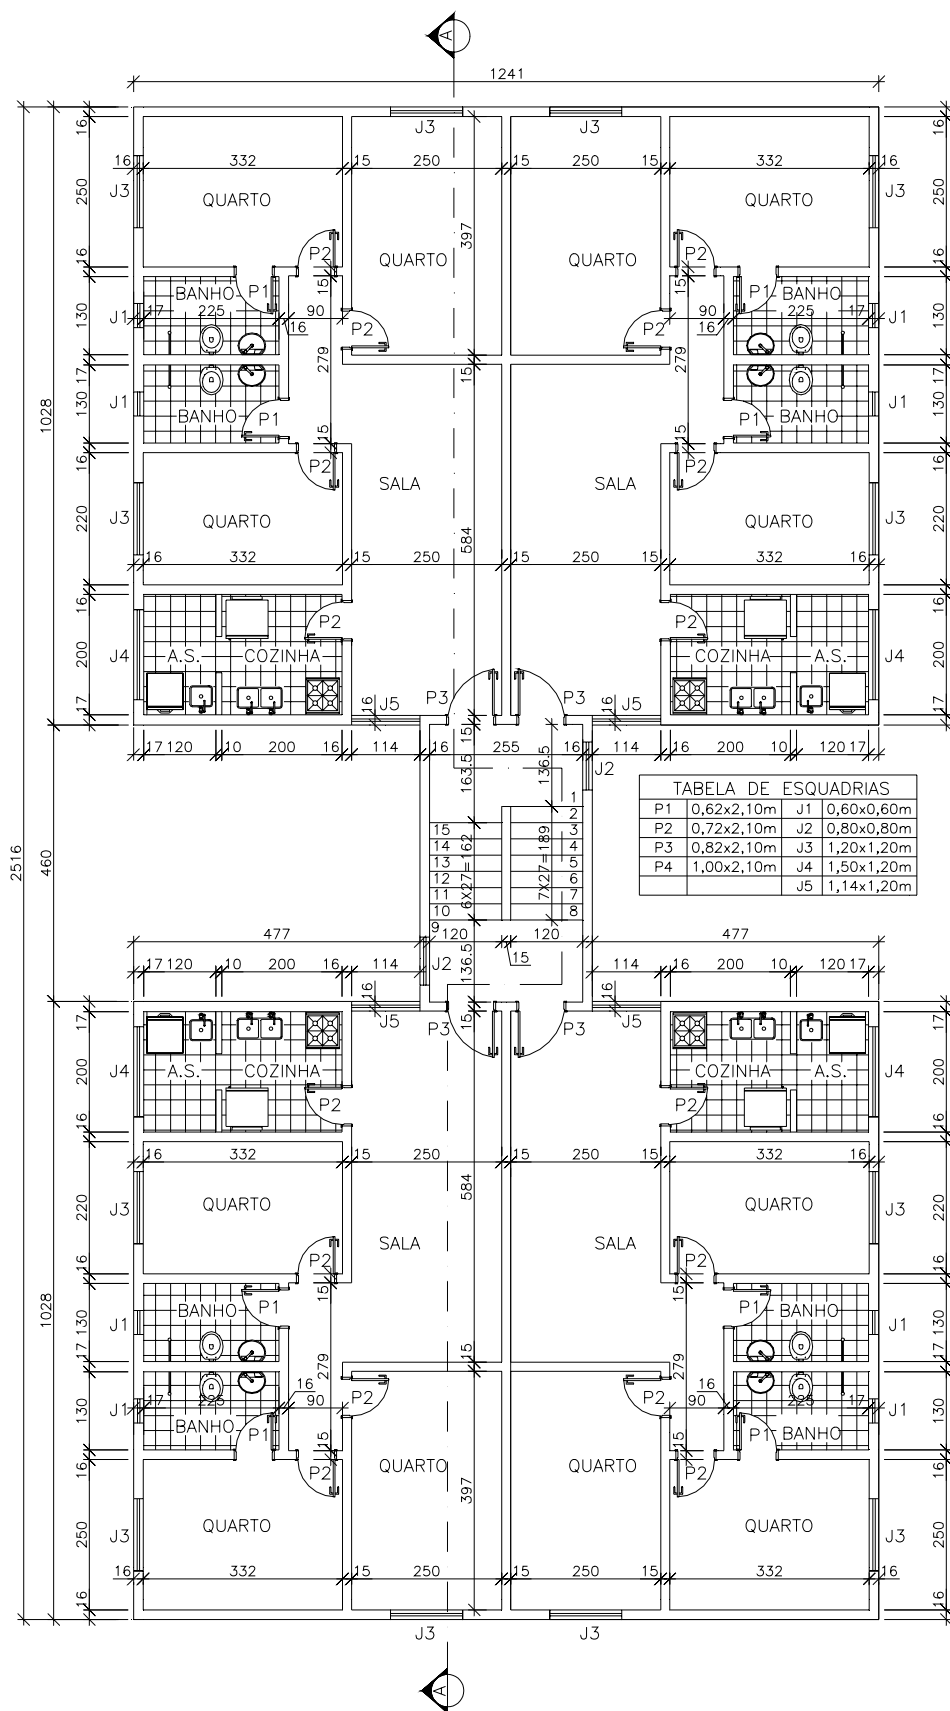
Prédio “C” – Planta com a arquitetura do pavimento tipo
